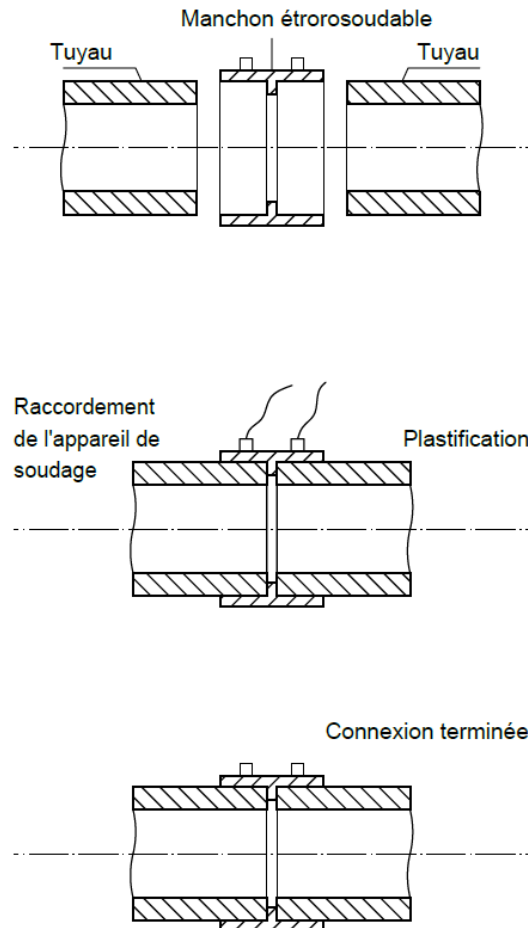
Soudage au moyen de manchons électrosoudables
